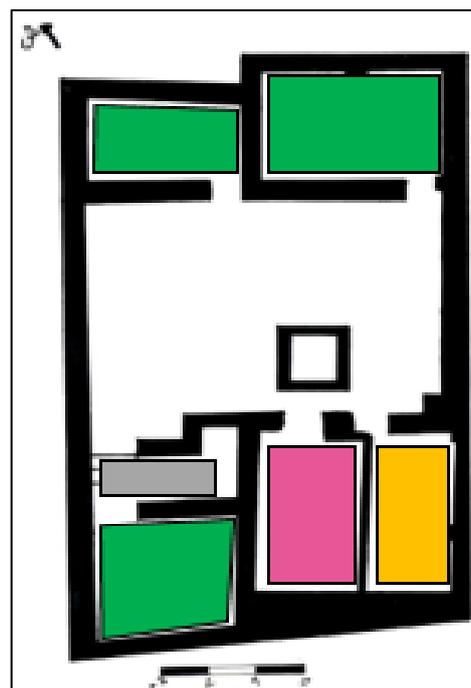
plan de l'étage d'une maison de ksar Taghit
